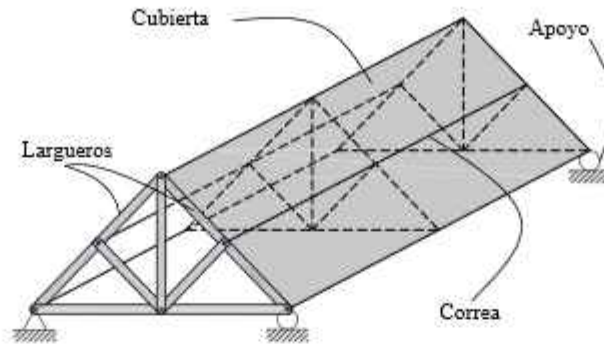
Uso de armaduras en estructuras metálicas - cubiertas
